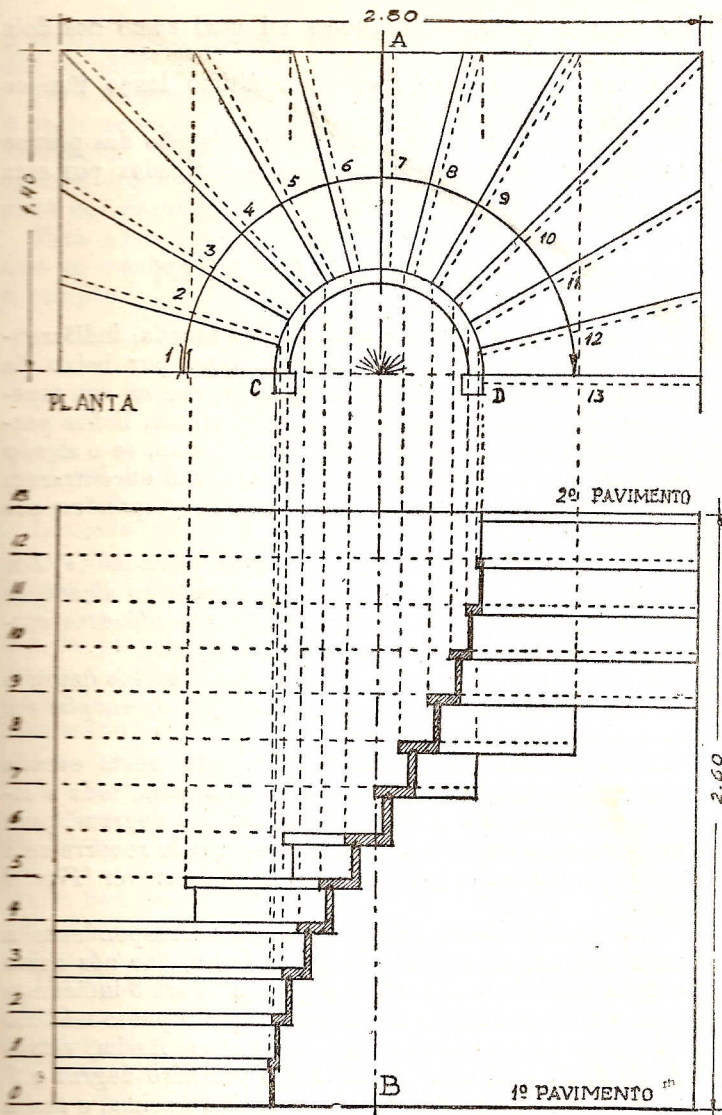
PLANTA DA ESCADA E TRAÇADO DA ELEVAÇÃO
